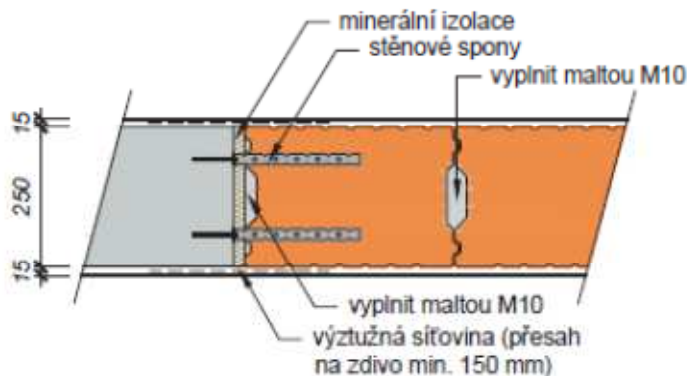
výřez - půdorys – skeletová k-ce s vyzdívanými stěnami
